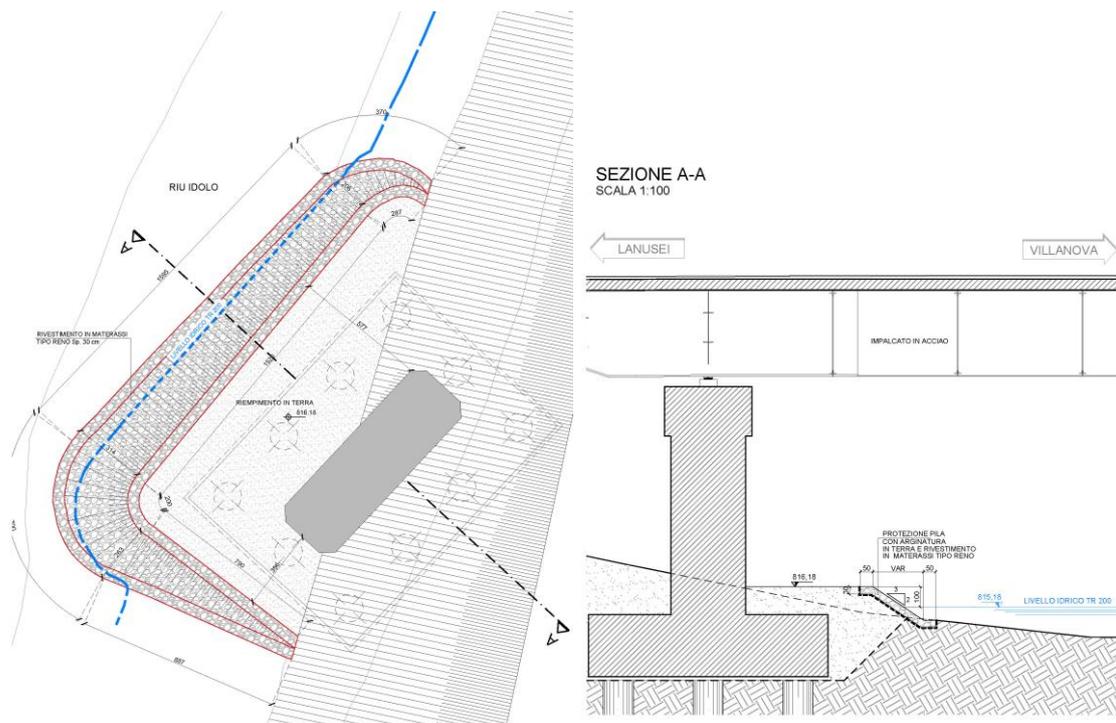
Riu Idolo – Pianta e sezione della protezione della pila.
